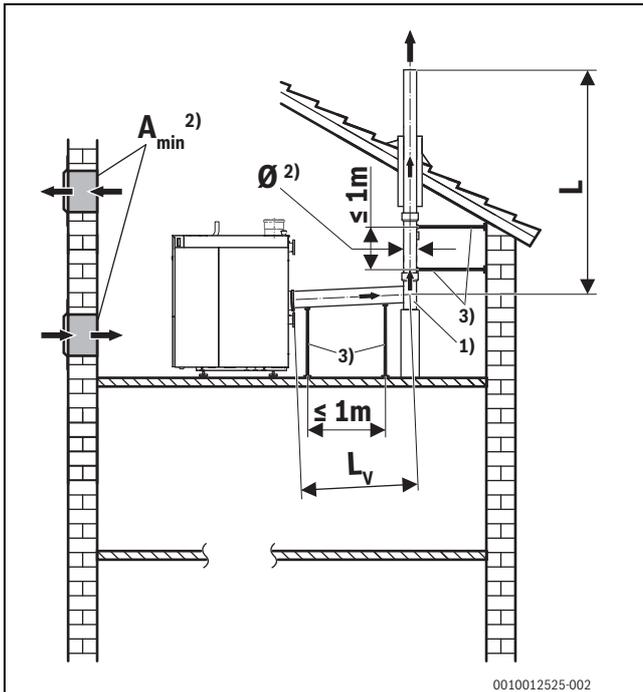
Abgasführung ohne Schacht, Dachzentrale, Variante 3
